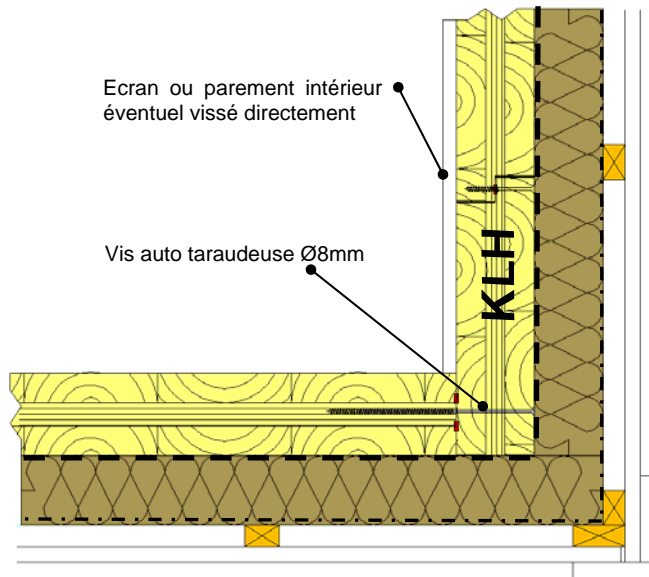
Coupe horizontale sur angle de murs extérieurs
